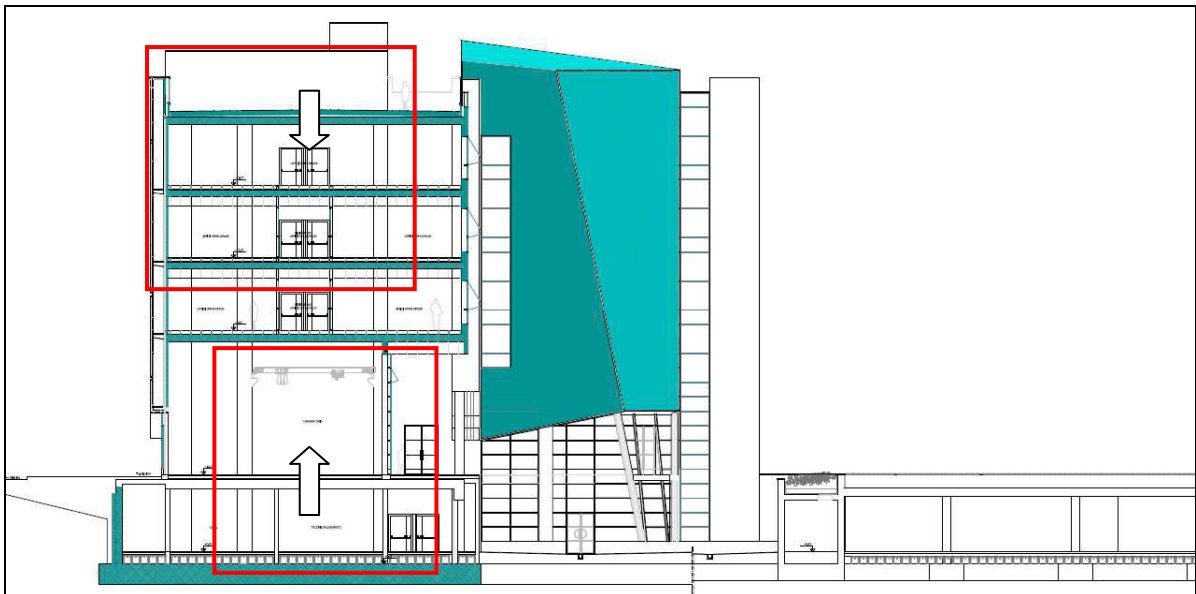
Sezione dell'edificio con indicazione della collocazione degli ambienti rispetto ai quali sono stati eseguiti i calcoli.
